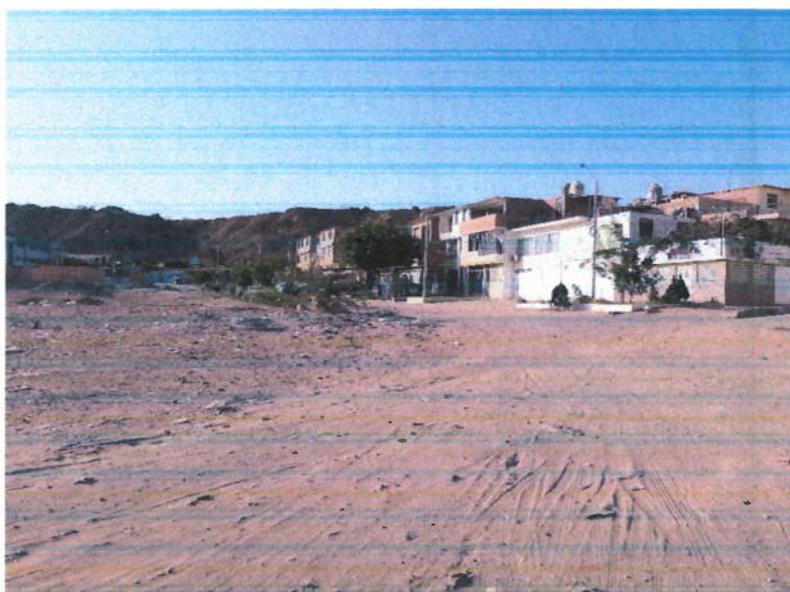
ACCESO DESDE VIA DENOMINADA CALLE 3 – URB. APROVISER
